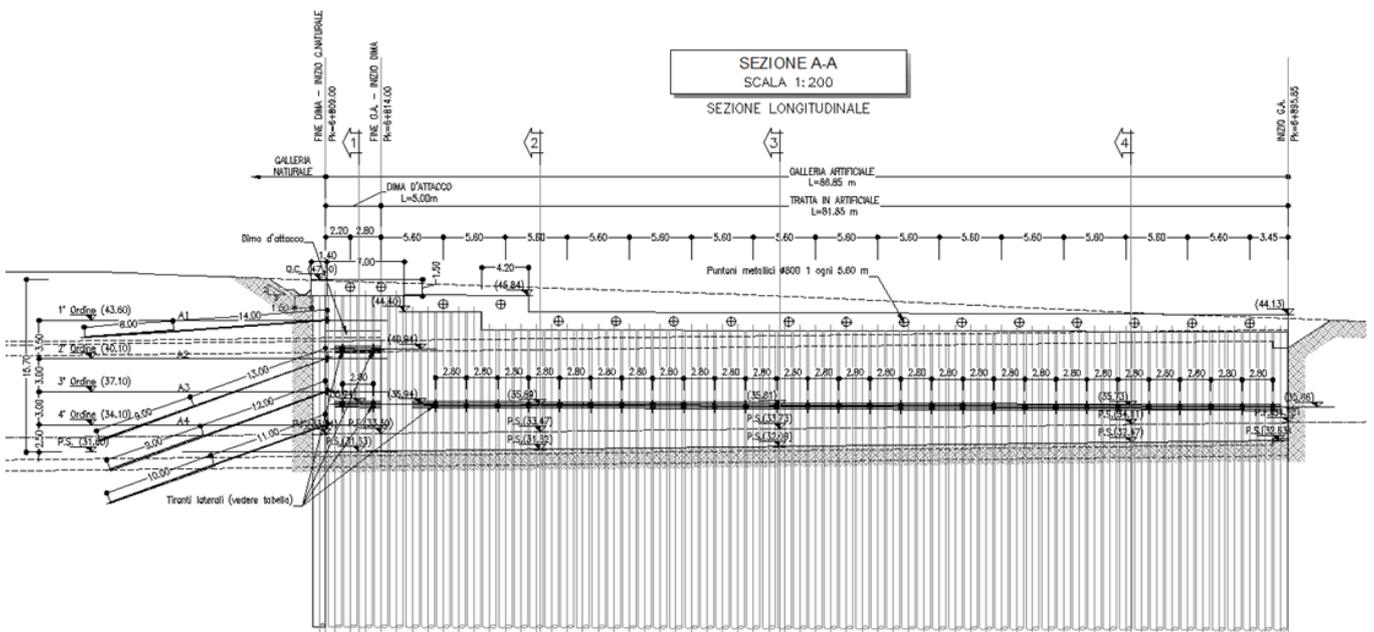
Prospetto imbocco GI02 – Imbocco lato Lesina
